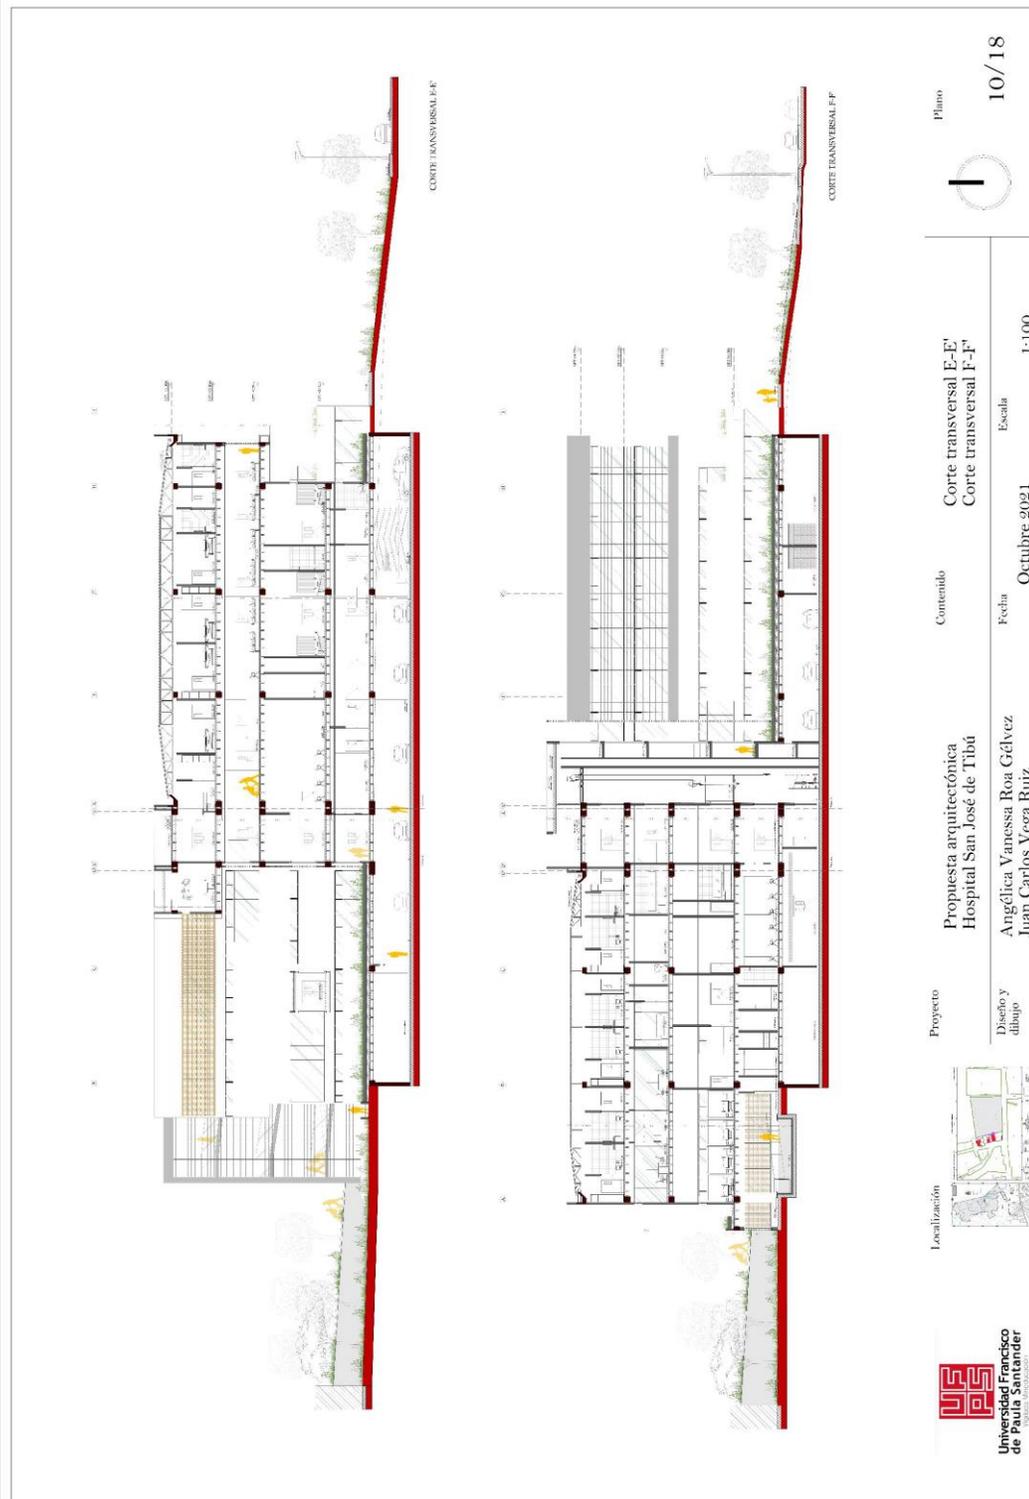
Corte transversal E-E', Corte transversal F-F'.
